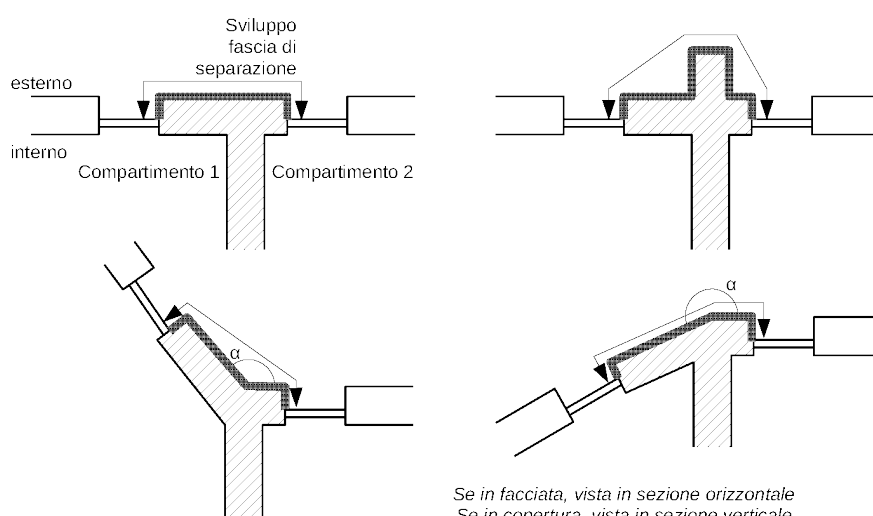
Esempi di fascia di separazione verticale in facciata o in copertura
